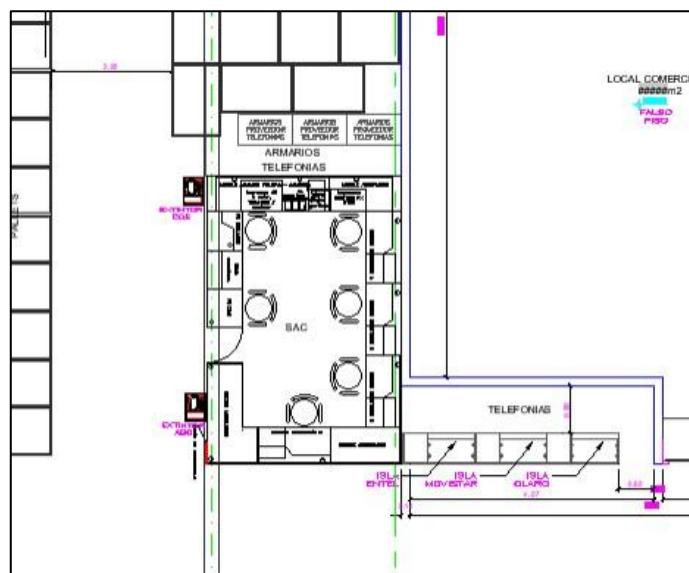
Plano Sector – área de almacén telefonías - Modificado
